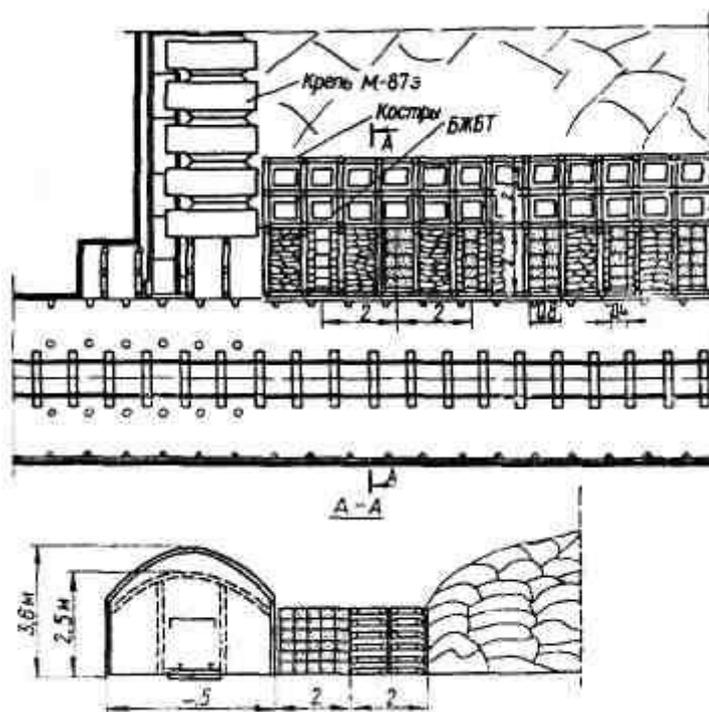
Схема охраны подготовительной выработки разрезными стенками из БЖБТ
